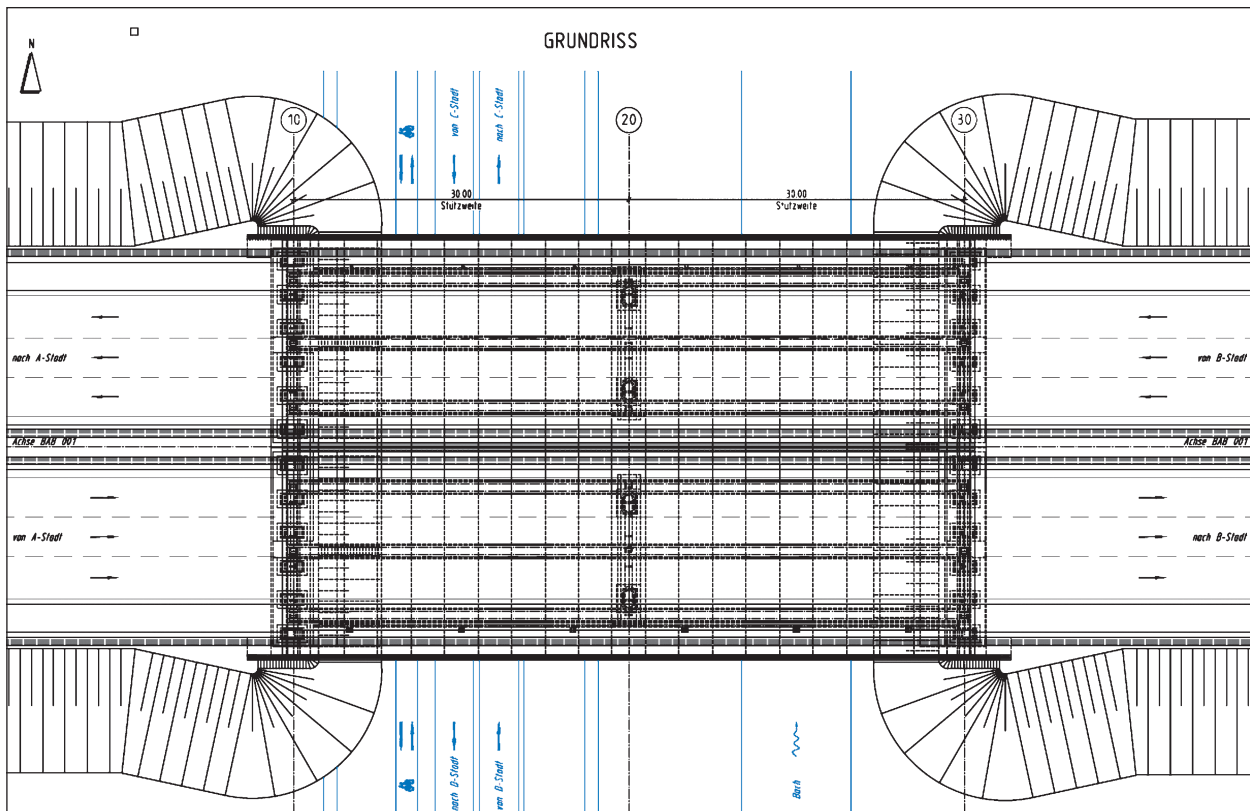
Grundriss Bauwerk 3 Zweifeldbauwerk
